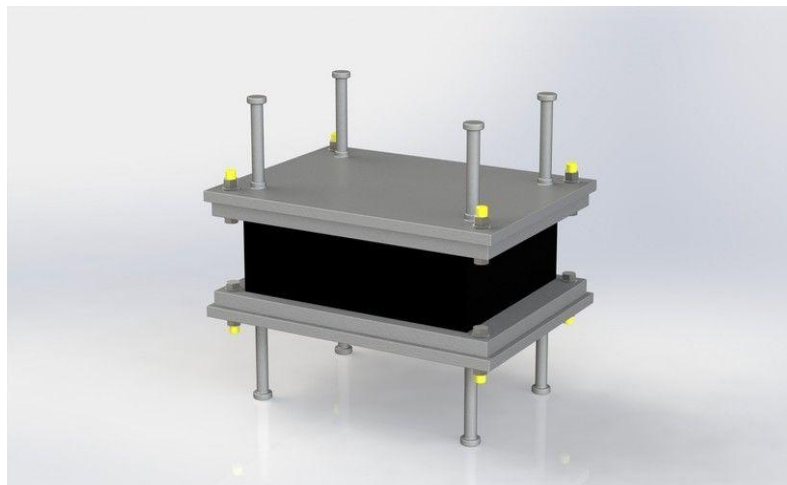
Aparelho de Apoio simples de Neoprene Cintado
